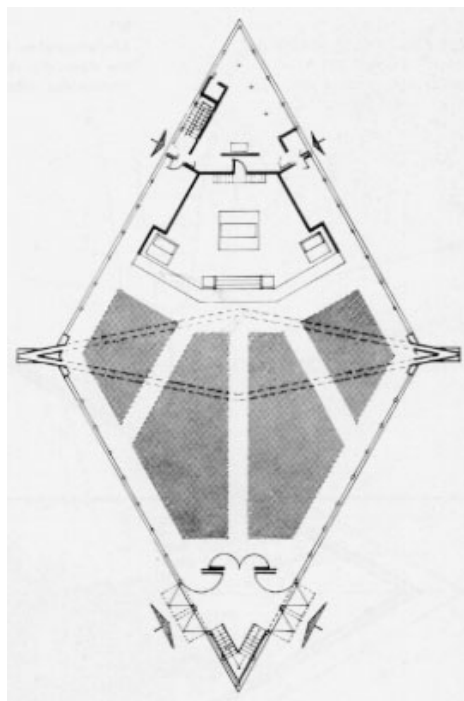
(links) Innenraum und Grundriss der Kirche San José Obrero zeigen den Widerspruch zwischen Tragkonstruktionsform und Grundrissgliederung.
